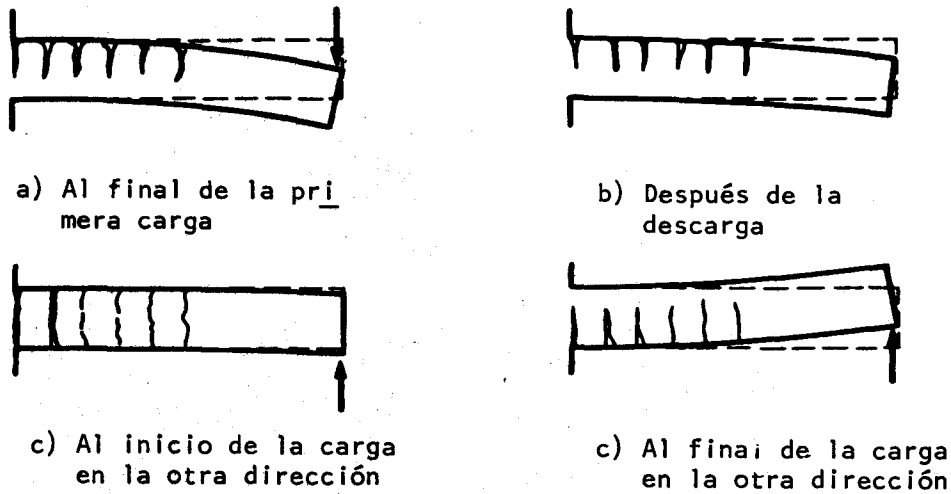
Efectos de cargas cíclicas en una viga en voladizo de concreto reforzado
